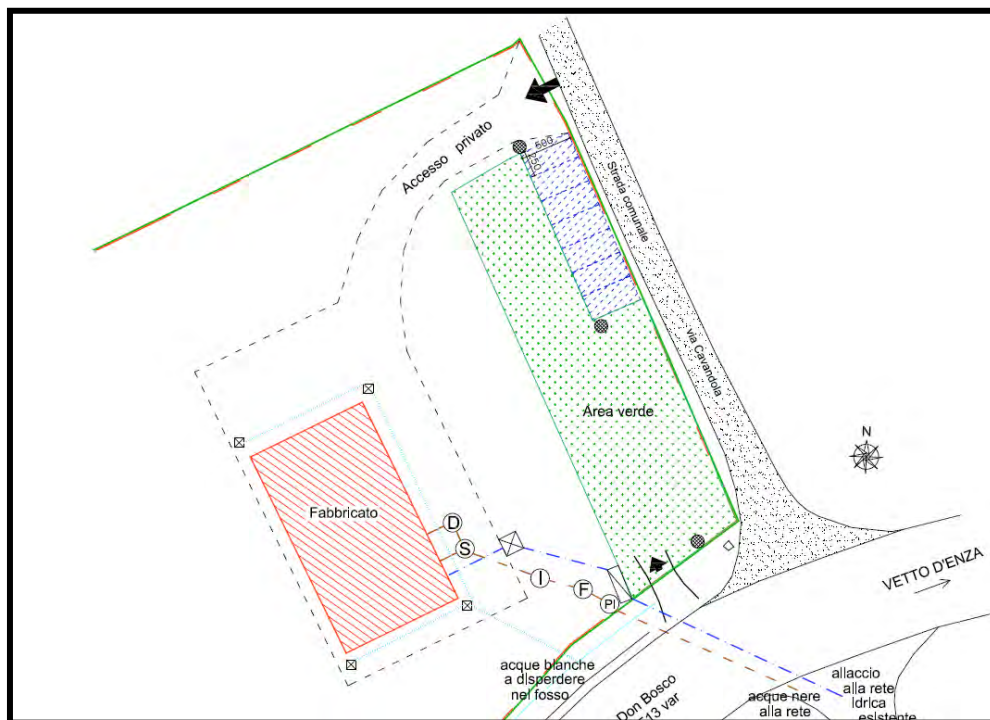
estratto della planimetria dell'area con indicazione del progetto proposto
